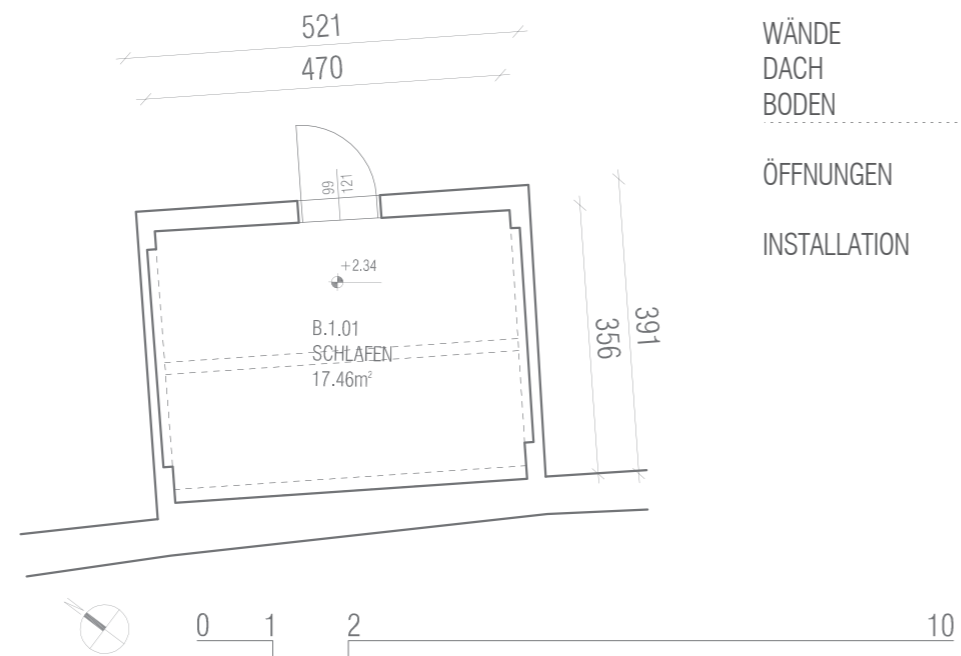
Grundriss Raum B.1.01_1:100
